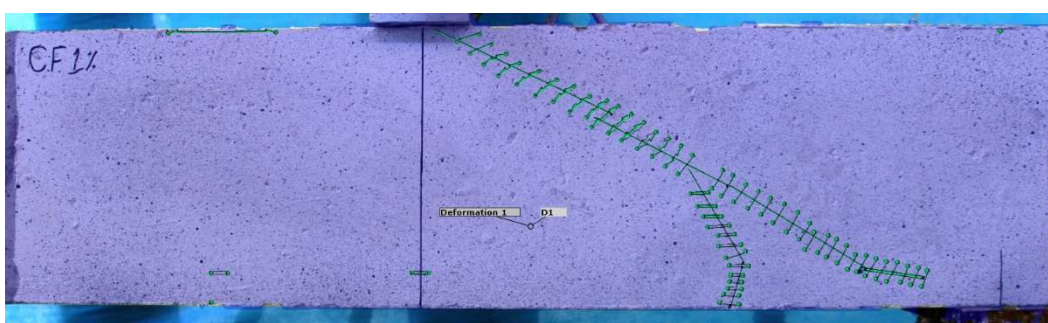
Formato simplificado da fissura diagonal crítica das vigas
